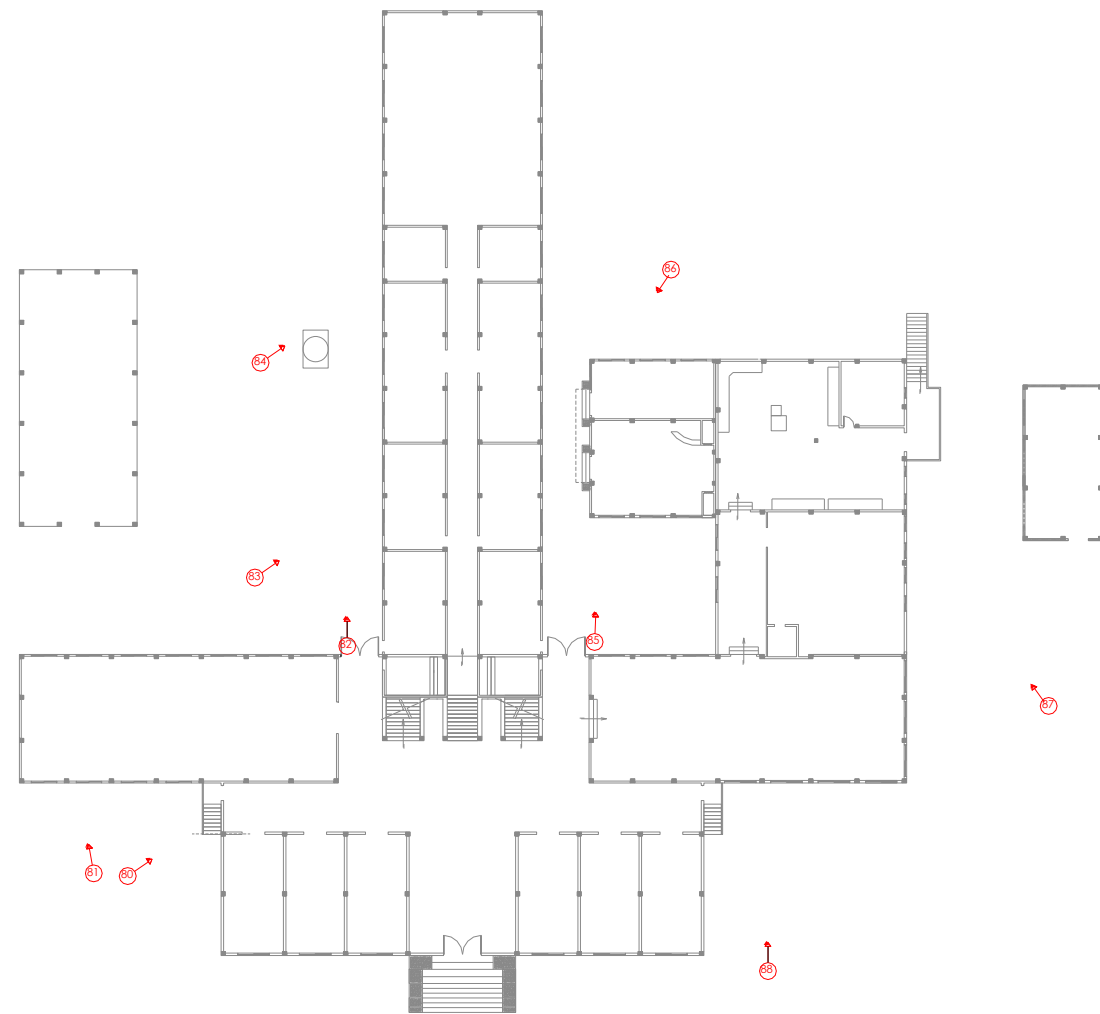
Planta Baja: Ubicación de vista de fotografía (80-88)
